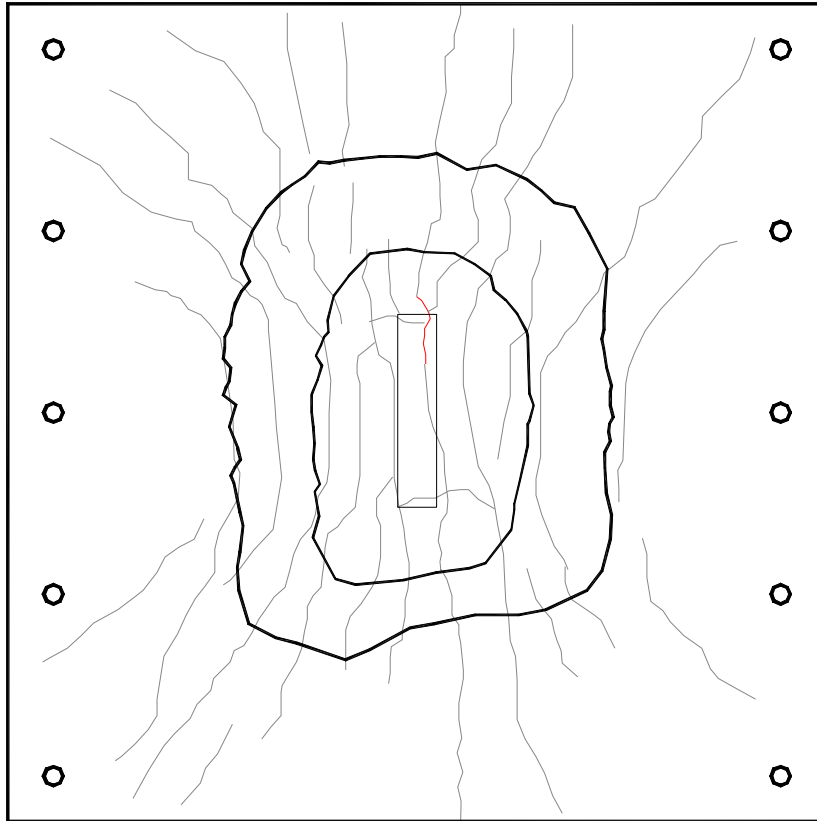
Mapa de fissuração da laje L3B
